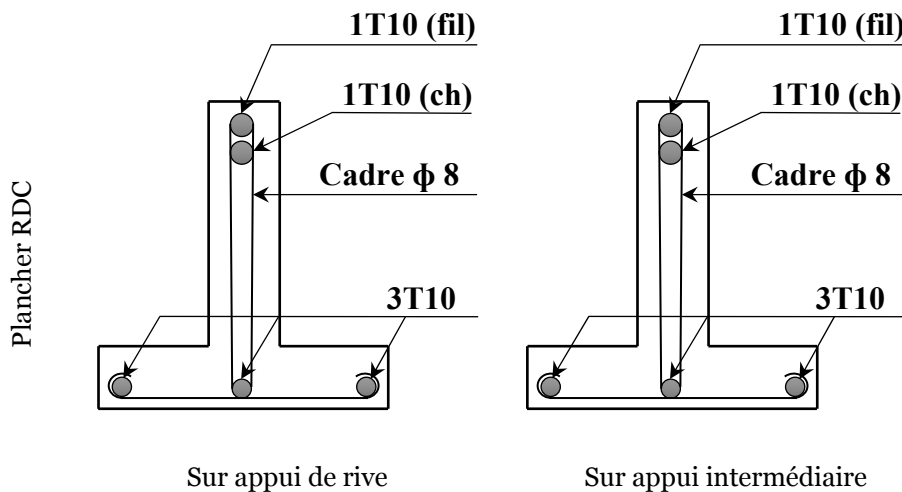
Dessin de ferrailage des poutrelles rdc
